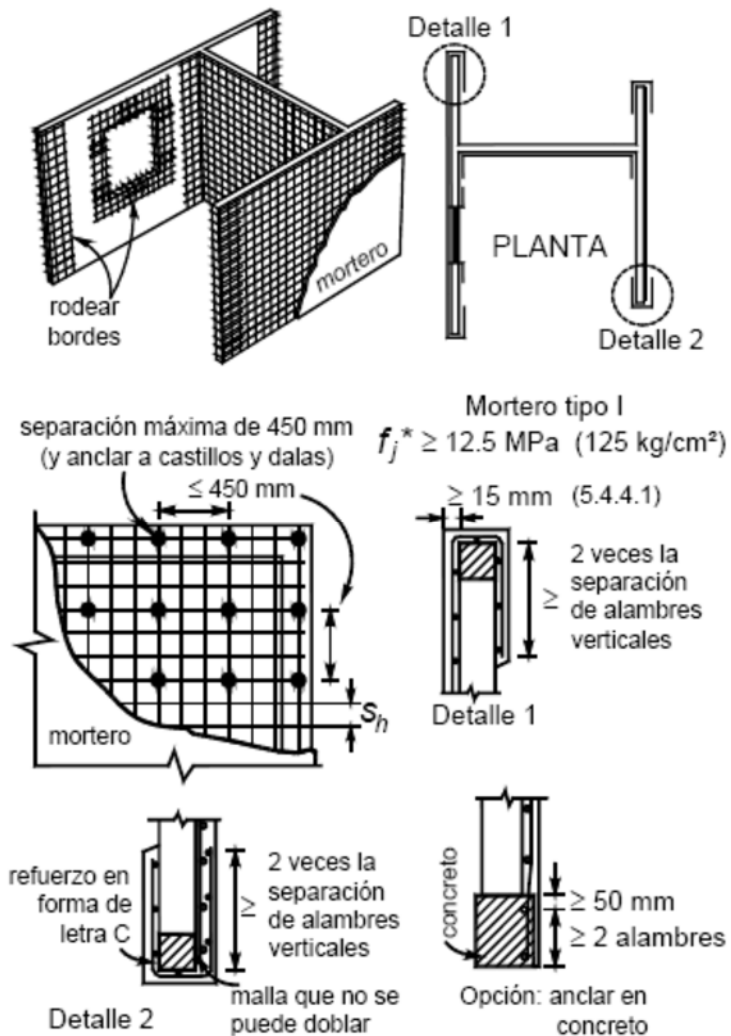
Refuerzo con malla de alambre soldado y recubrimiento de mortero.
